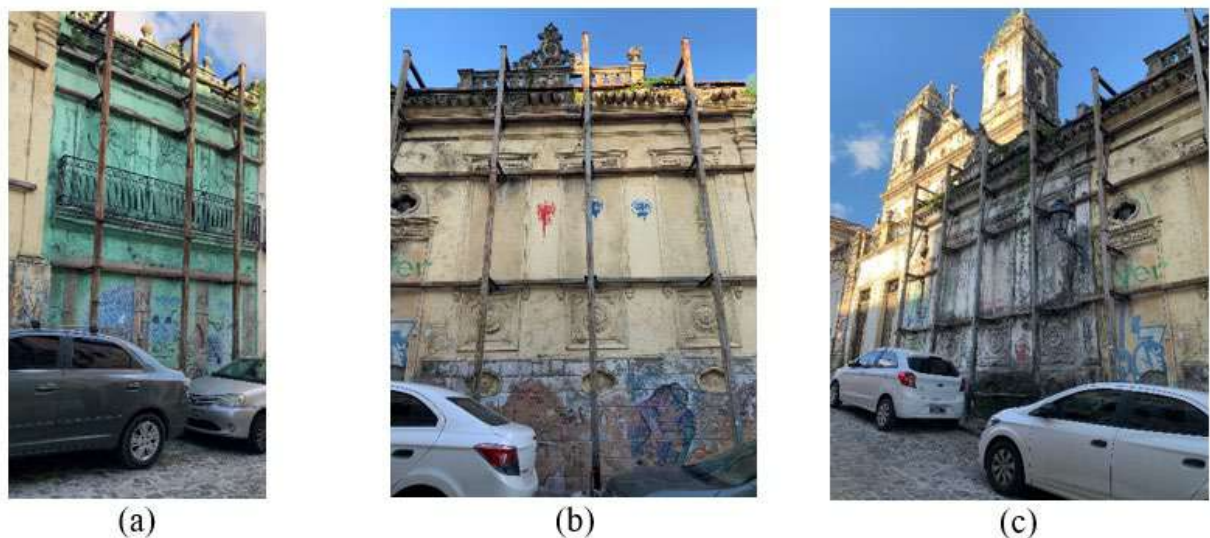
Fachadas principais dos casarões (a) n° 41; (b) n° 43; (c) n° 45.
